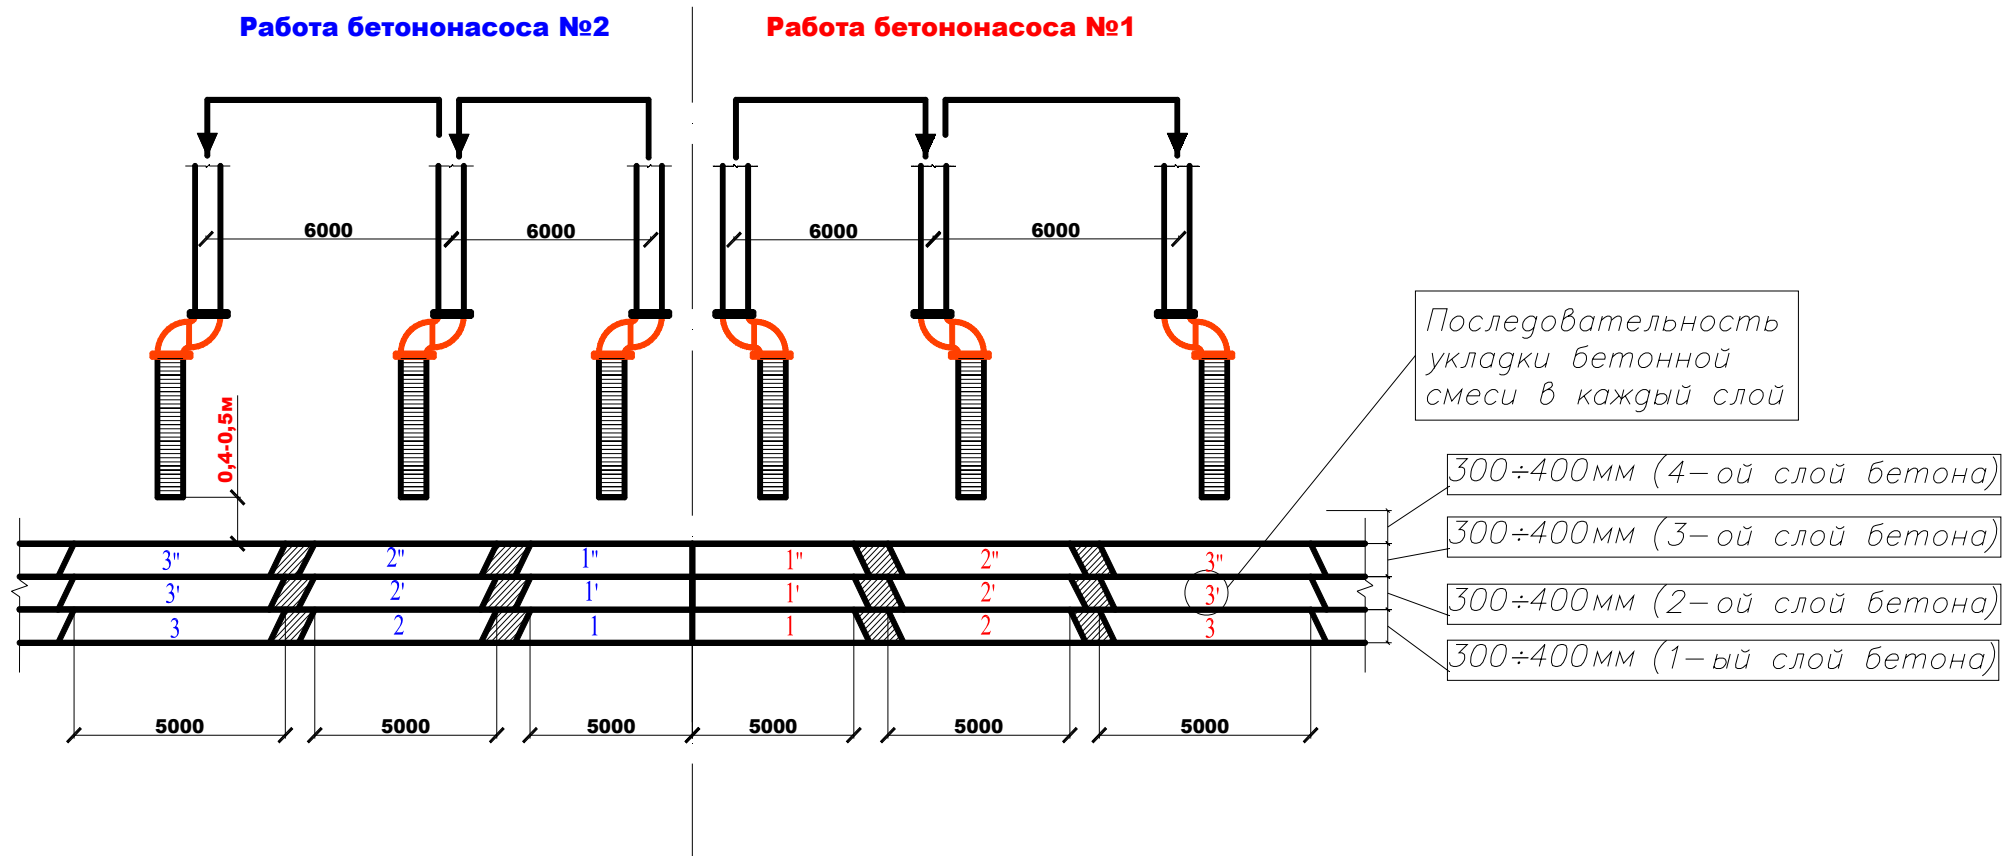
Схема укладки слоев бетона при бетонировании внутренней защитной оболочки
